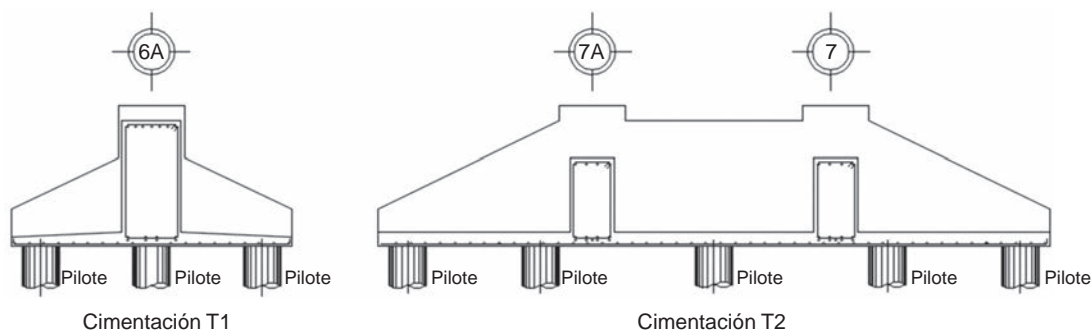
Croquis de zapata aislada apoyada en pilotes de fricción.
